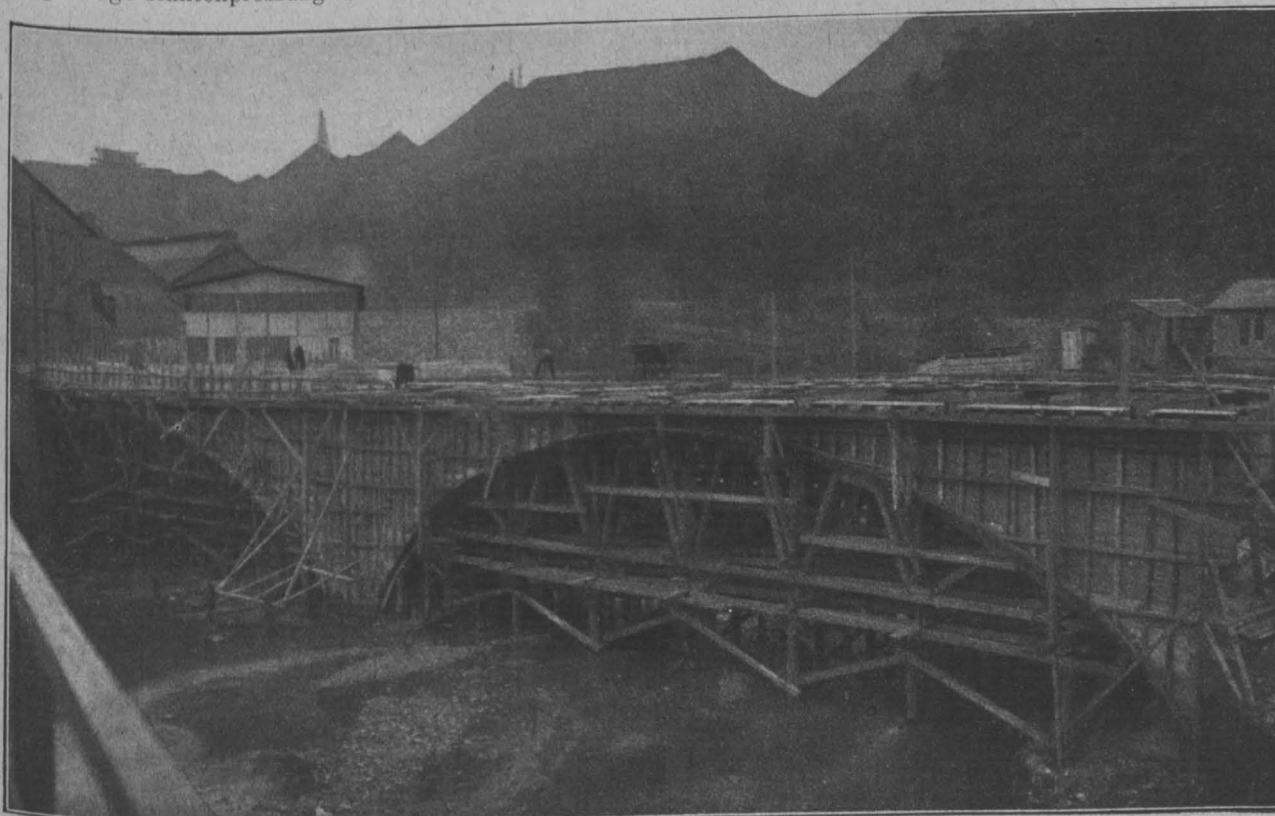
Brückengewölbe mit Lehrgerüst und Stirnschalung.
